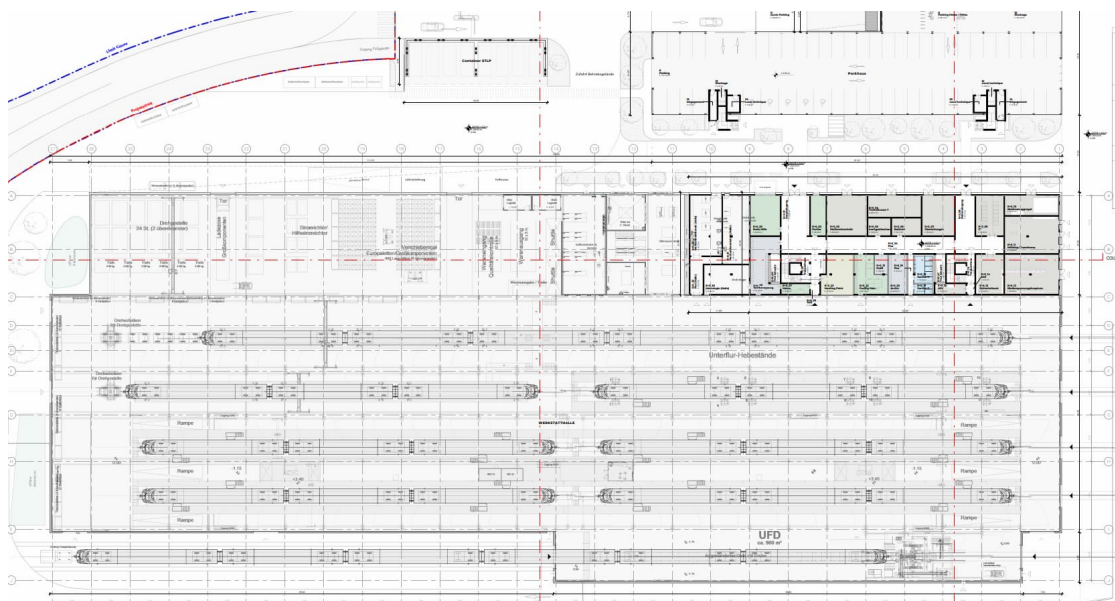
Plan du RDC Werkstatt et UFD-Halle (WW+)
